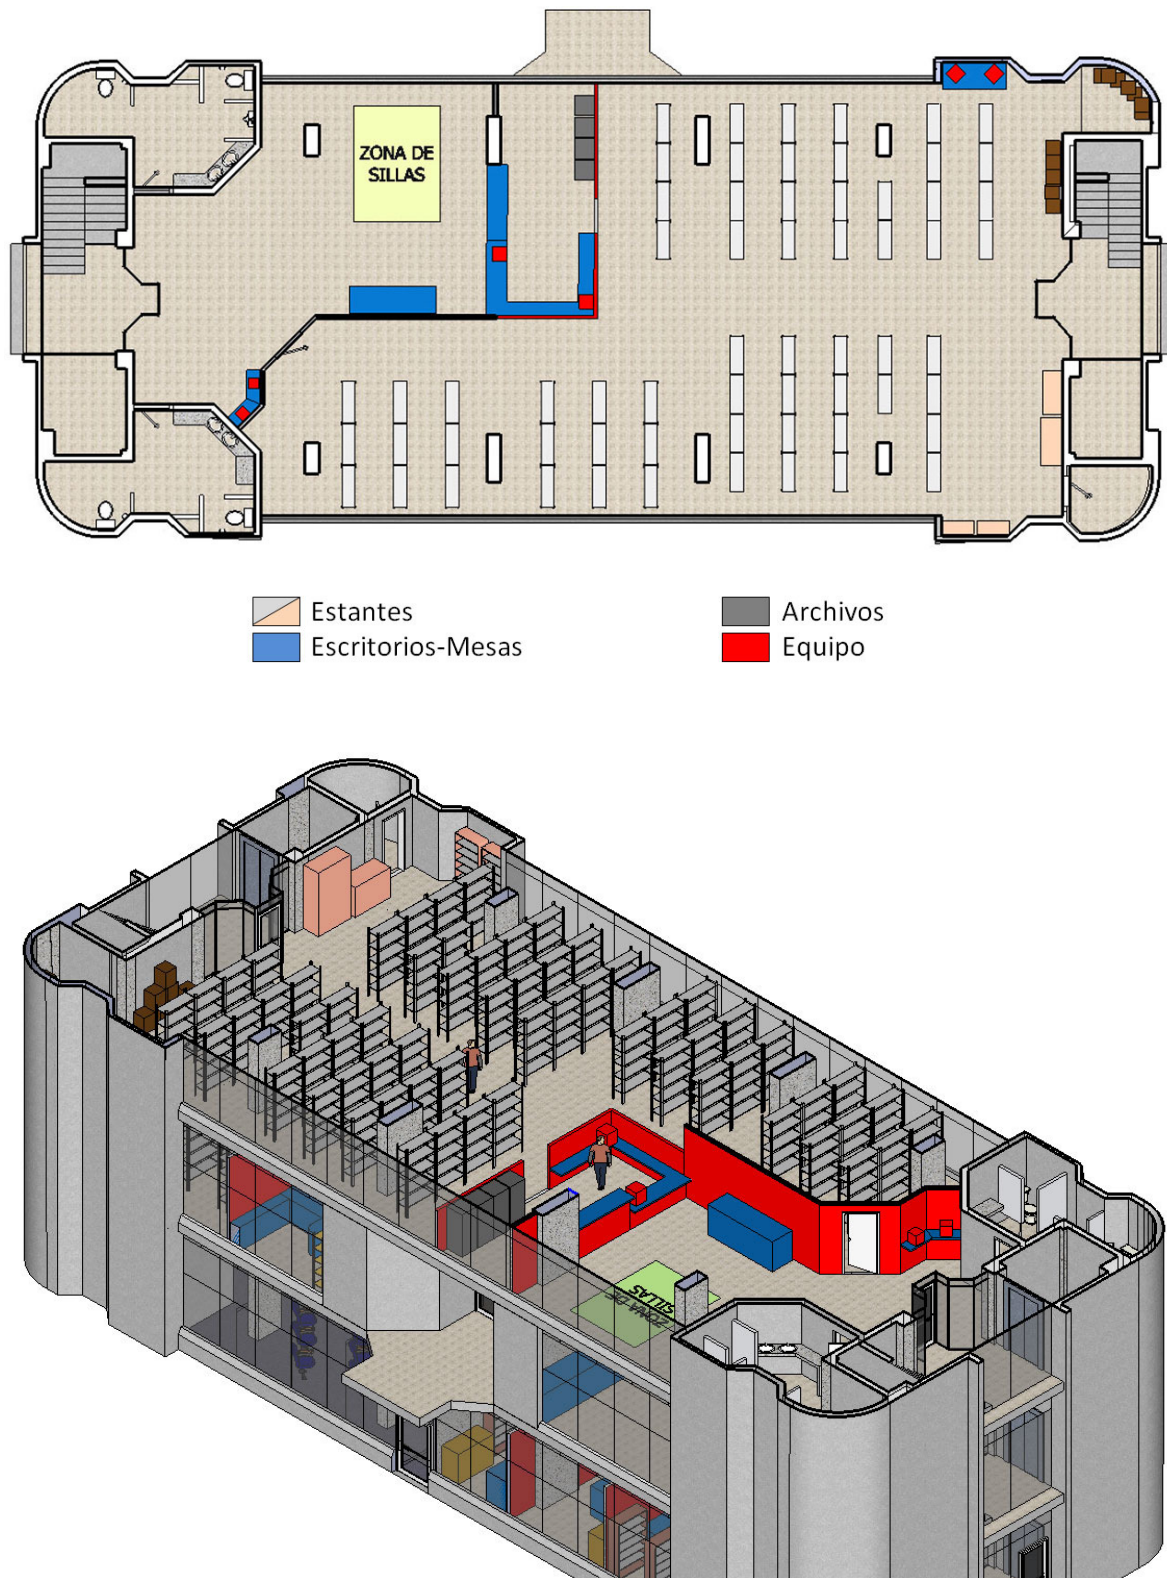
Ubicación de elementos no estructurales en la Biblioteca de Salud: Piso dos.
